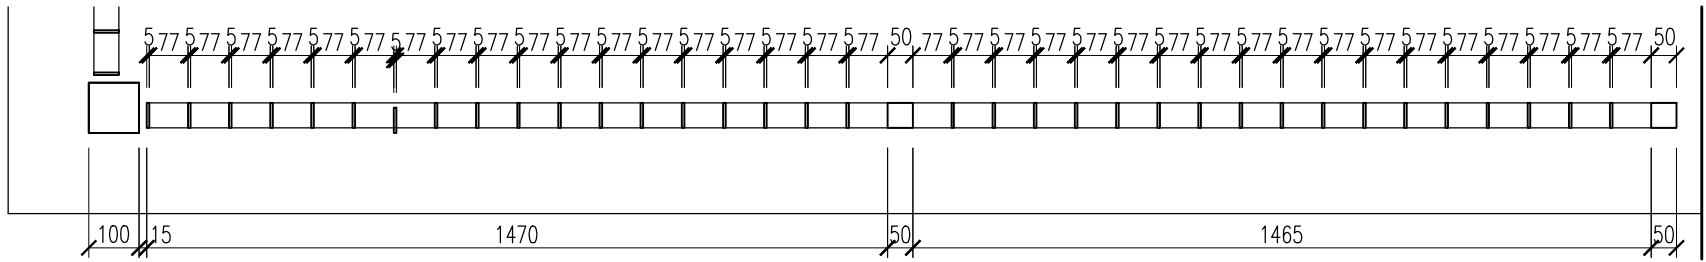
DETAIL PŮDORYS ZÁBRADLÍ U SLOUPKU ZASTŘEŠENÍ
